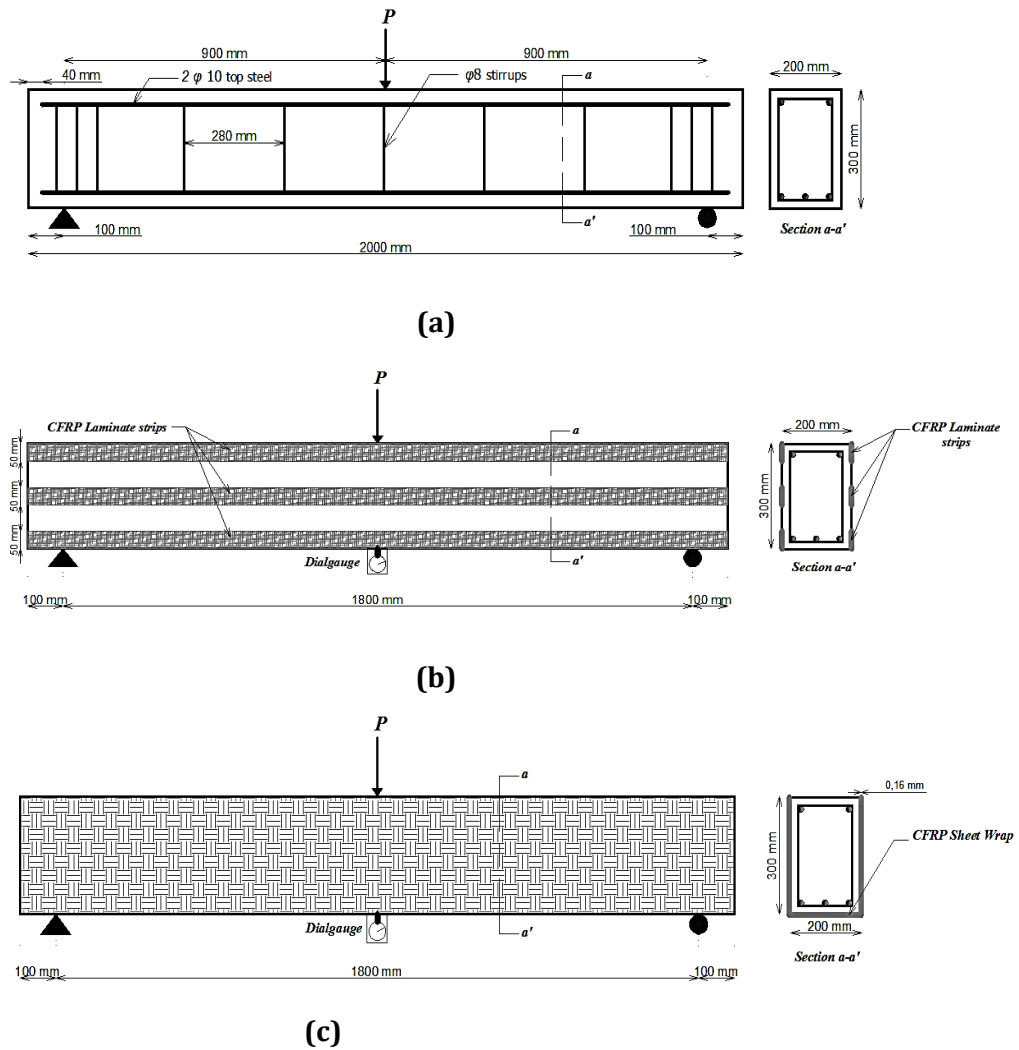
Détails de renforcement, (a) dimensions de la section transversale de la poutre (b) bandes horizontales ; (c) feuille enveloppée en U [50].
